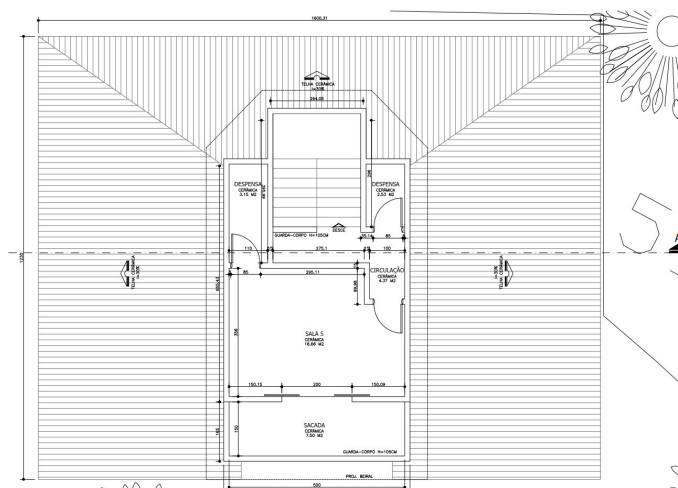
Primeiro pavimento da edificação. Fonte: os próprios autores.
